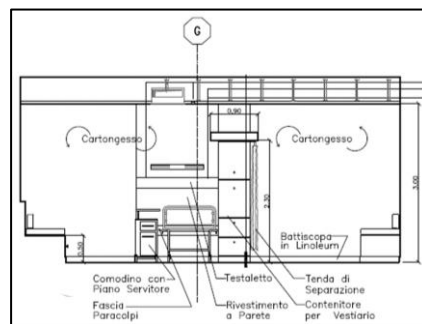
Pianta piano secondo. Unità di degenza.
